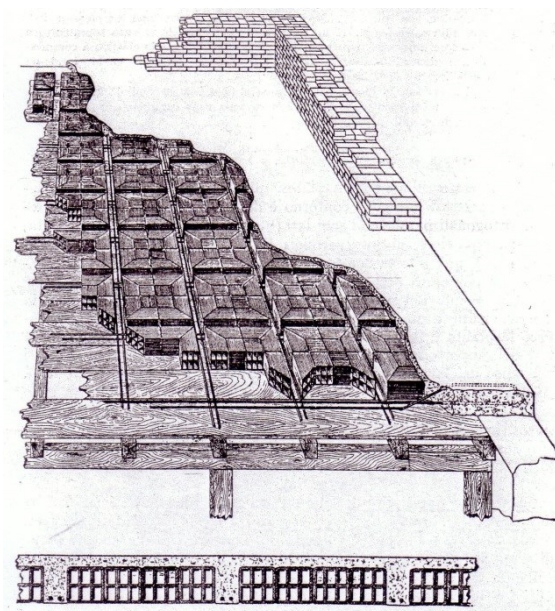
Assonometria e sezione del solaio “Duplex” [292]
